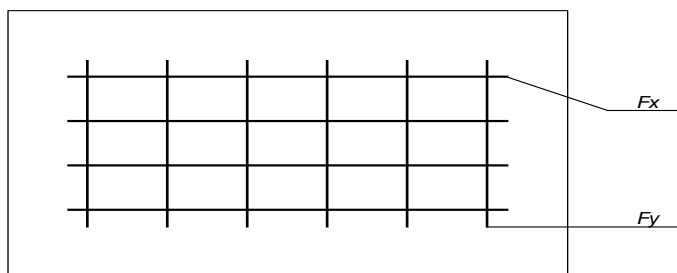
Армирование плиты в пролете(нижняя арматура)
